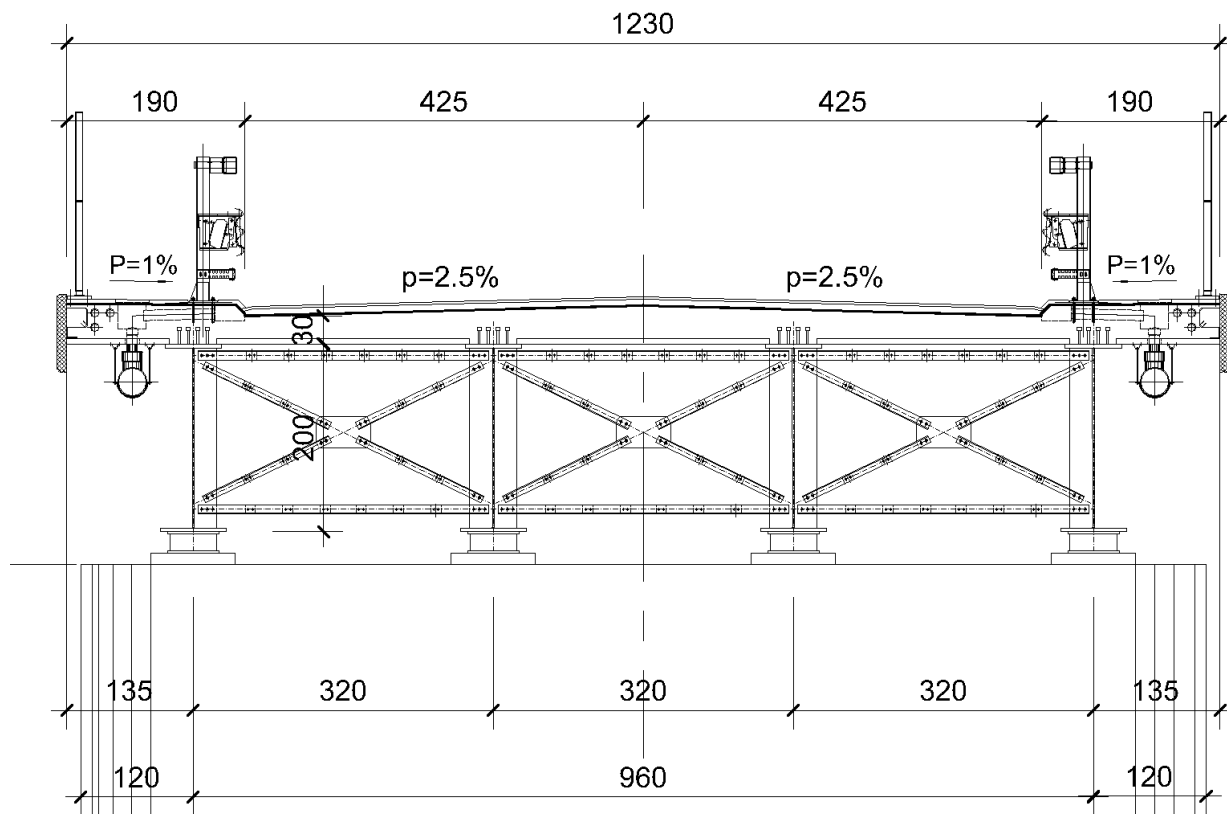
SEZIONE IMPALCATO (SU PILA)
